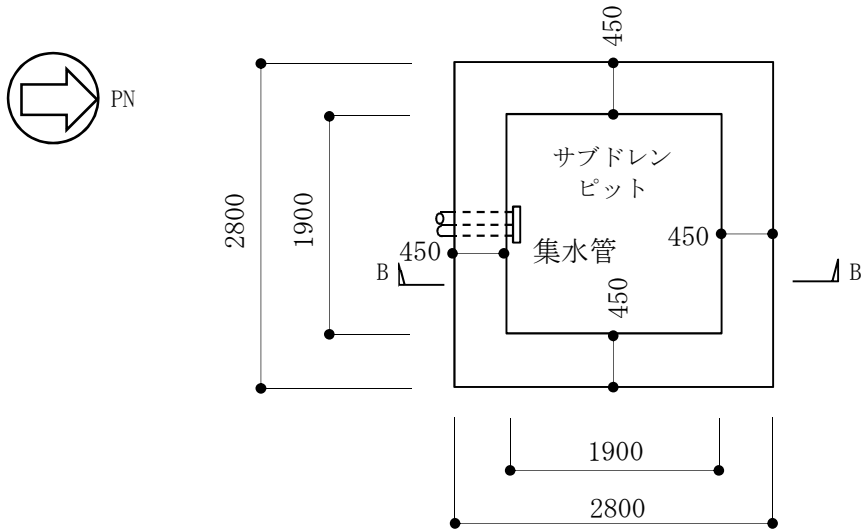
タービン建屋サブドレンピットの概略平面図 (T. M. S. L. -13.05m) (単位 : mm)
